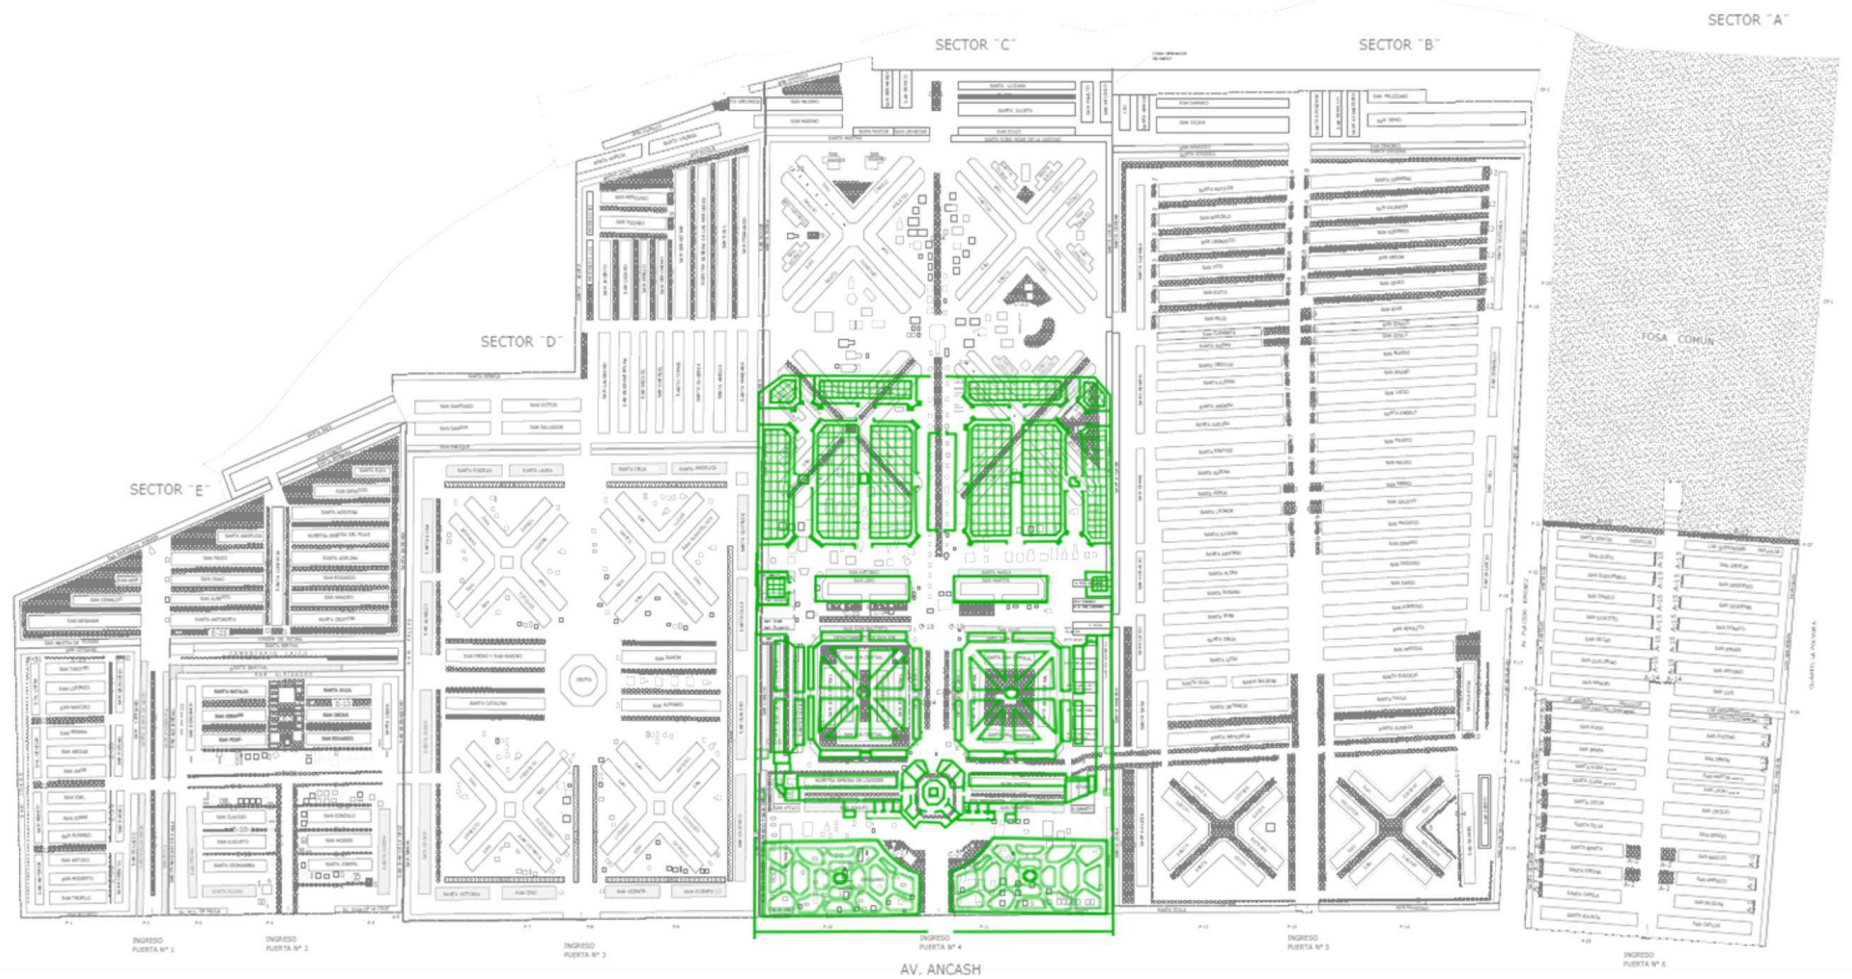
Propuesta de plano de 1807 sobrepuesto al plano actual. Fuente: Elaborado por la autora en base al plano actual y plano de Antonio Pereira y Ruiz de 1816.
